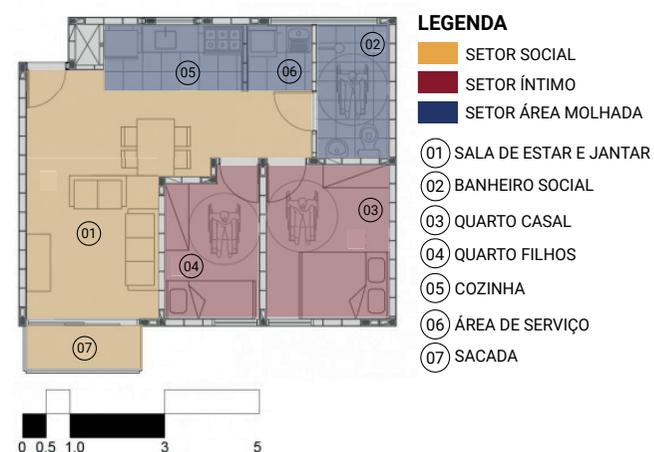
Planta baixa do apartamento tipo A adaptada. Fonte: Biselli & Katchborian Arquitetos, adaptado pela autora.
